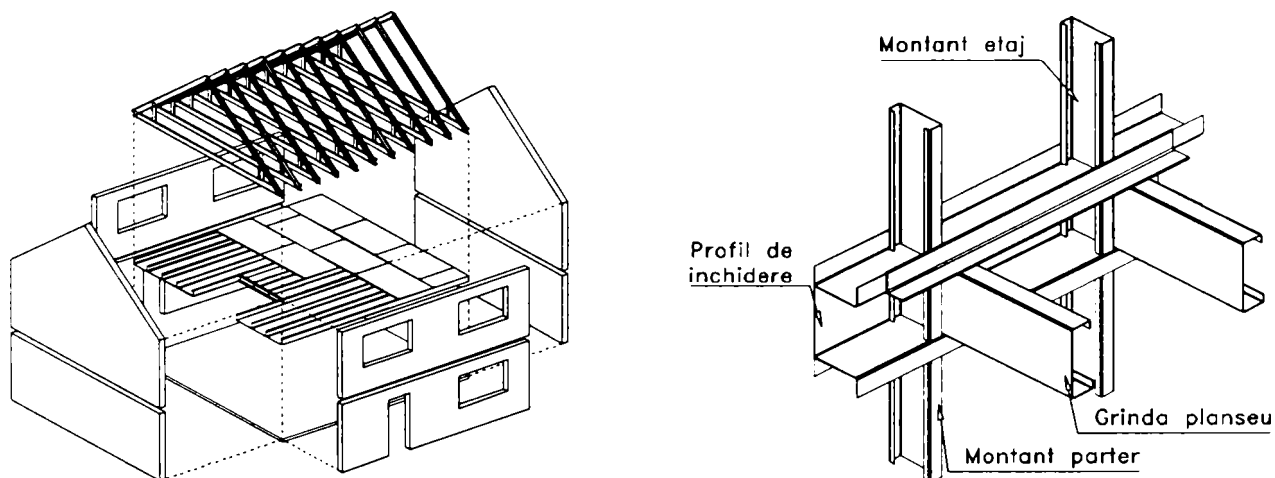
CONSTRUCȚIE PRIN METODA PLATFORMĂ CU ÎMBINARE TIPICĂ PERETE PLANȘEU
